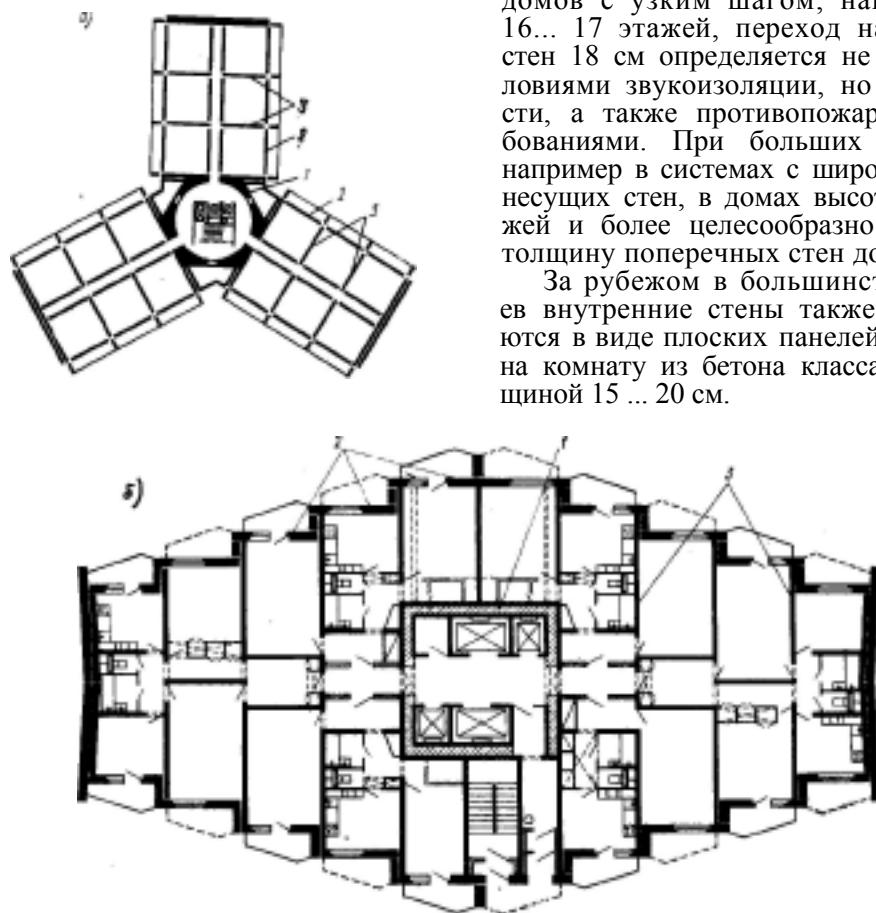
Схема панельного дома с ядром жесткости (план типового этажа):
